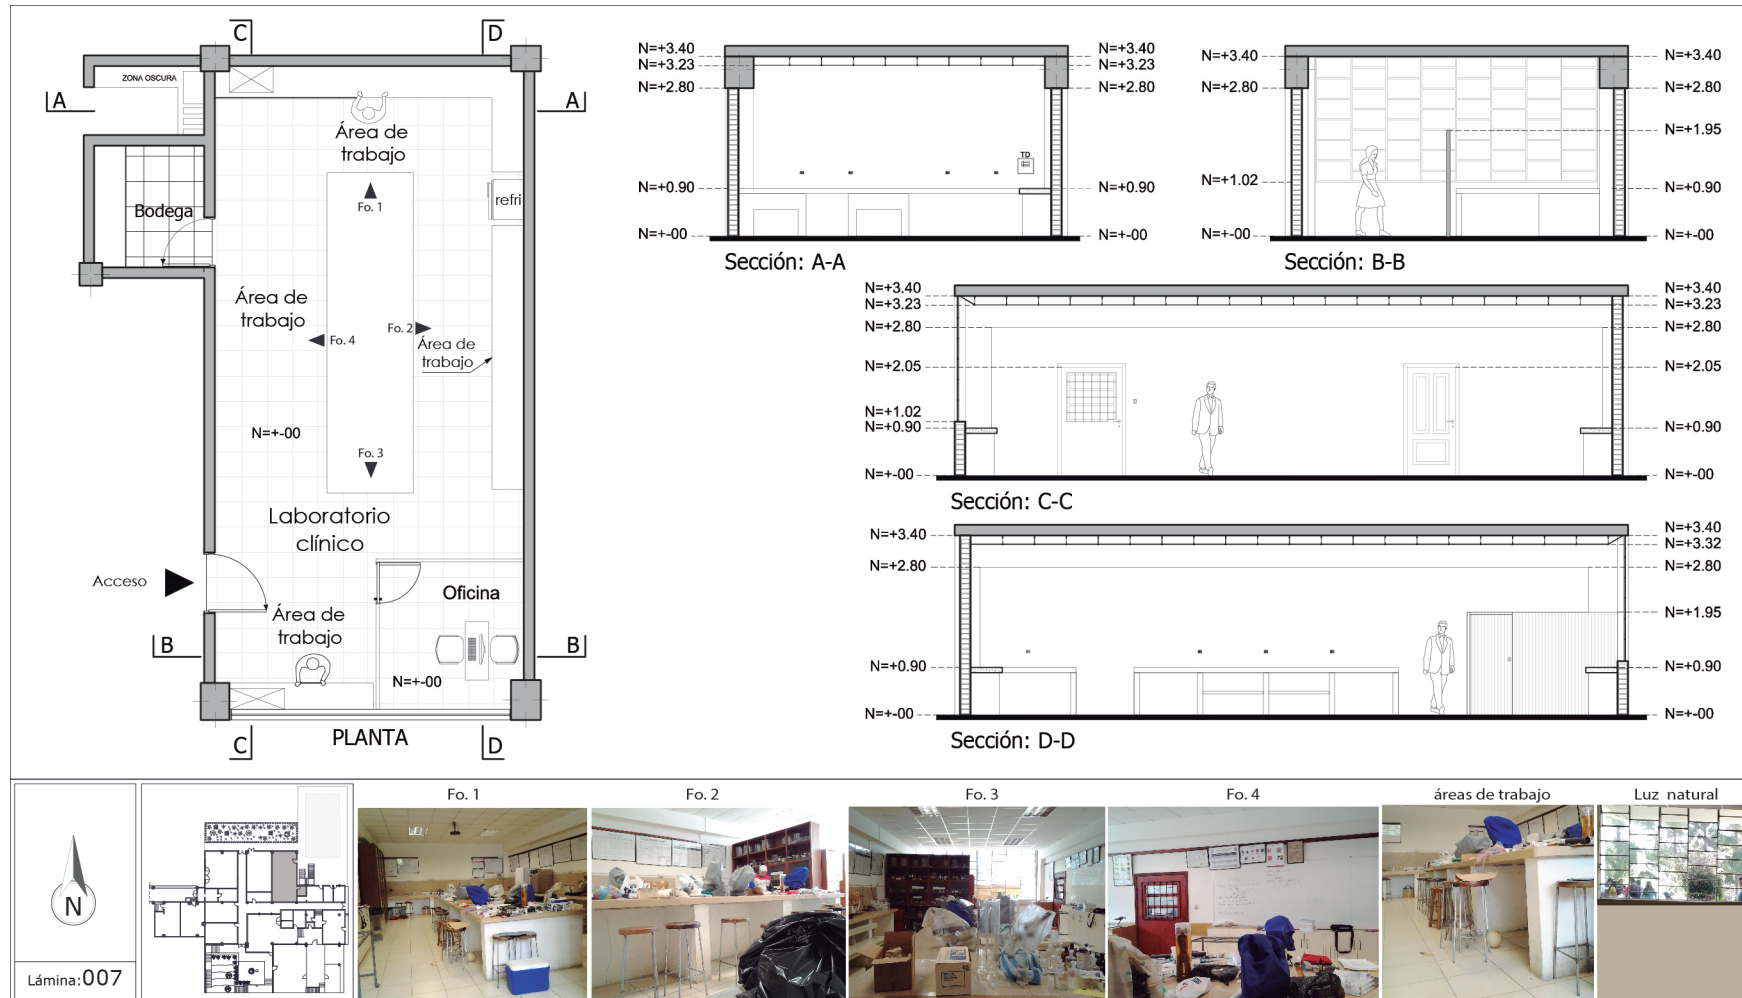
Planta y secciones del laboratorio clínico estado actual.
